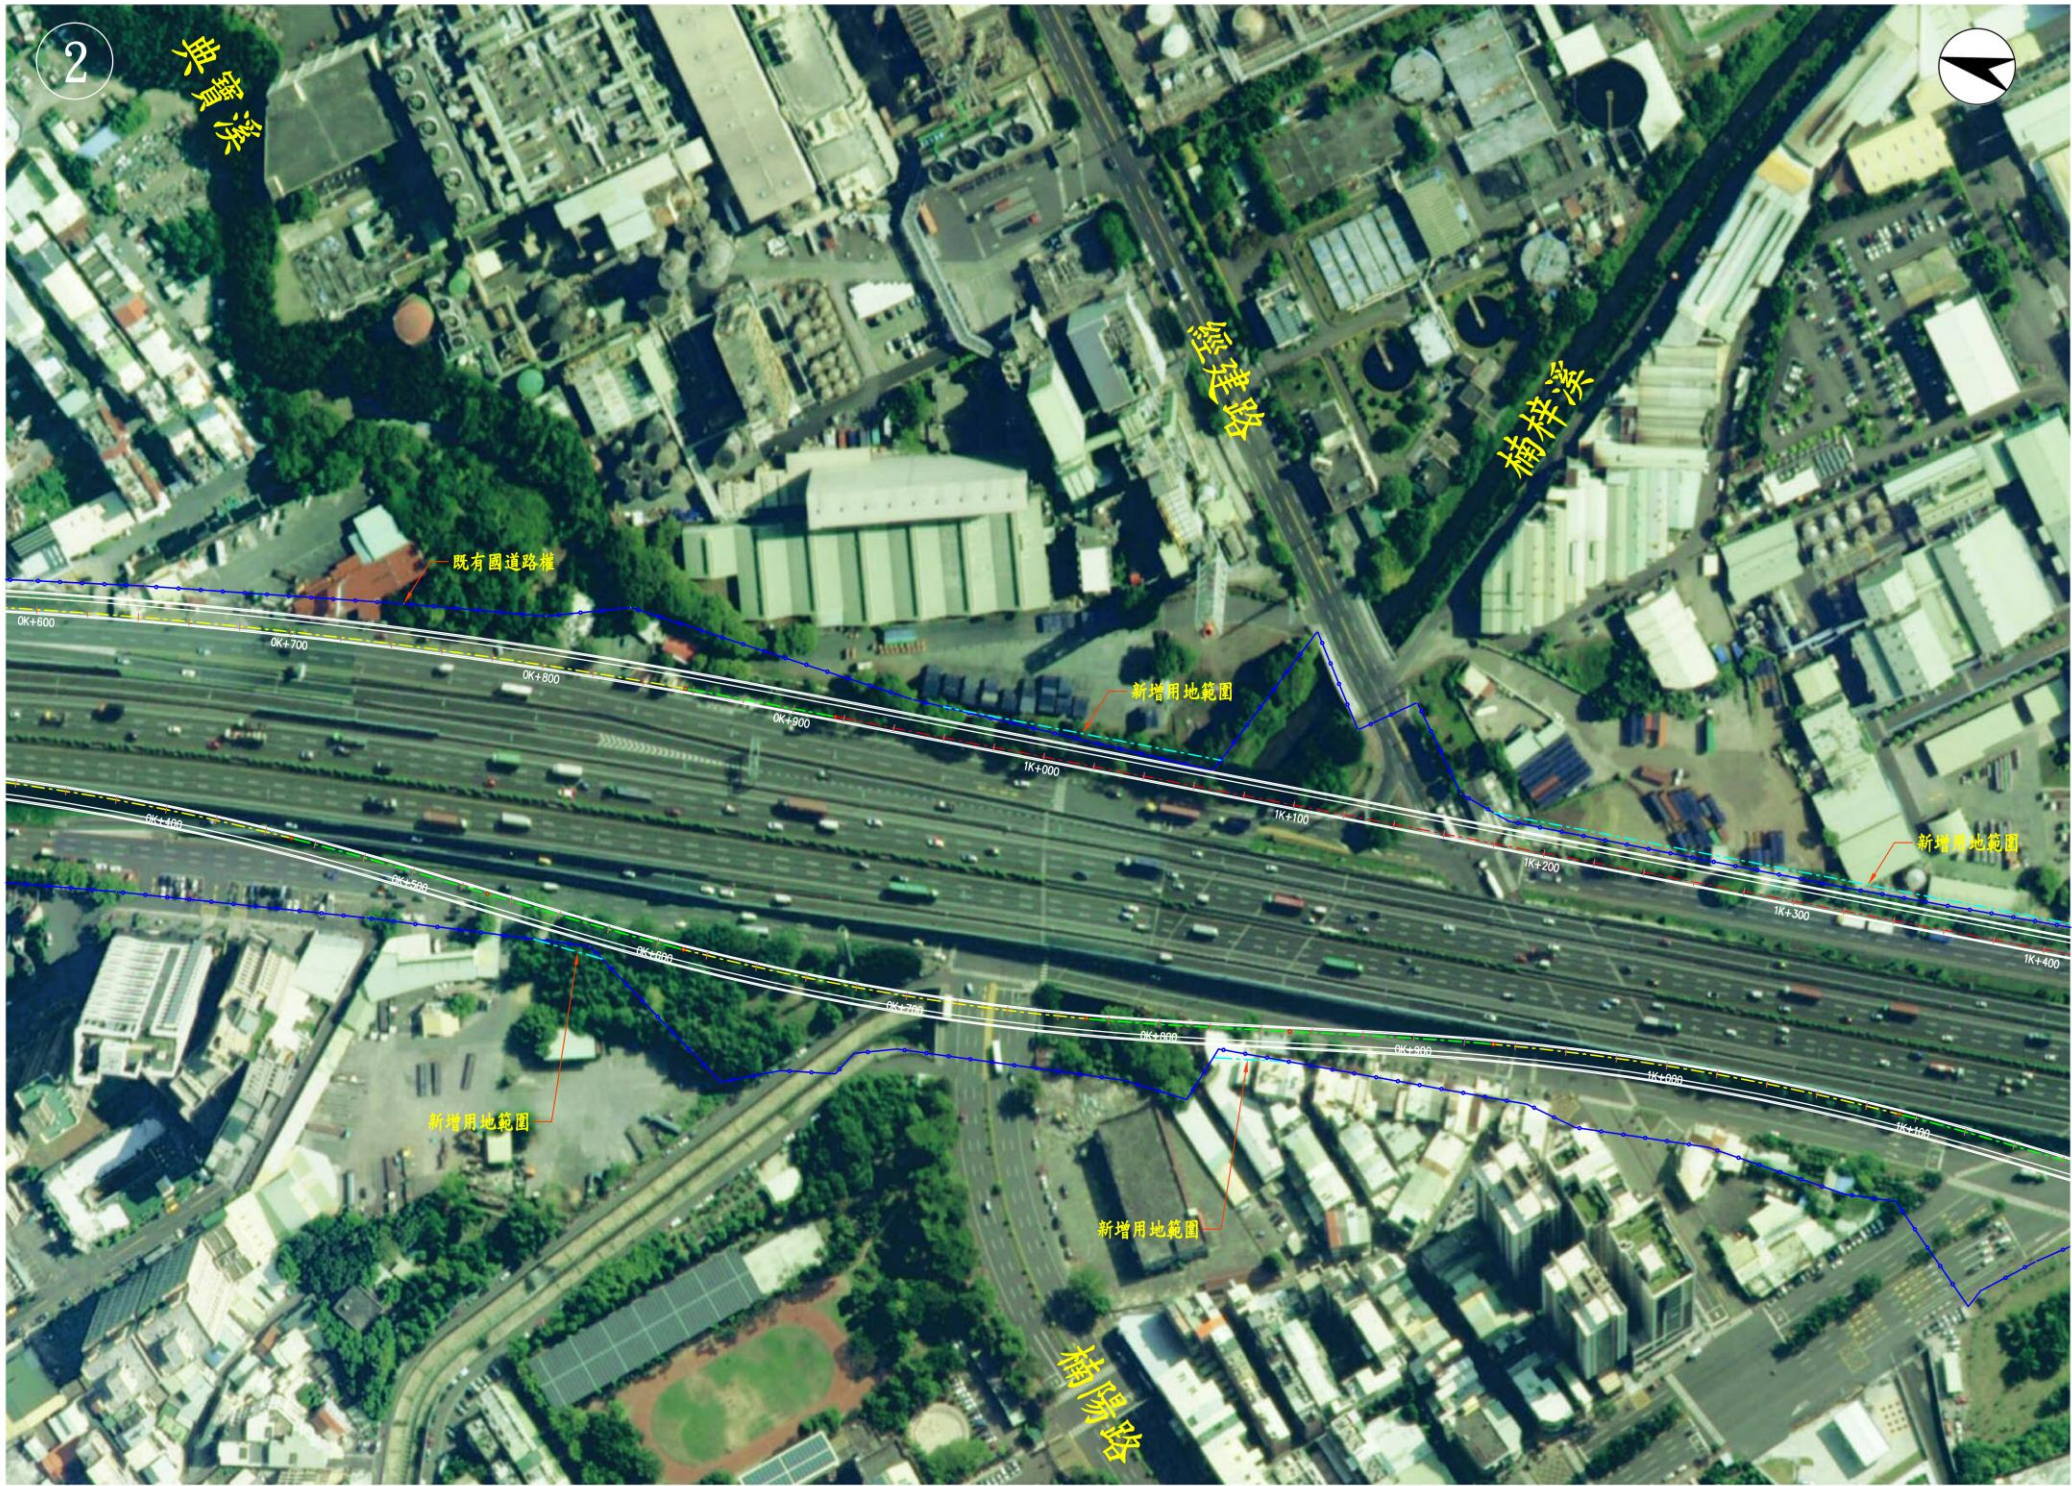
新增楠梓匝道及連絡道路線平面示意圖(二)
